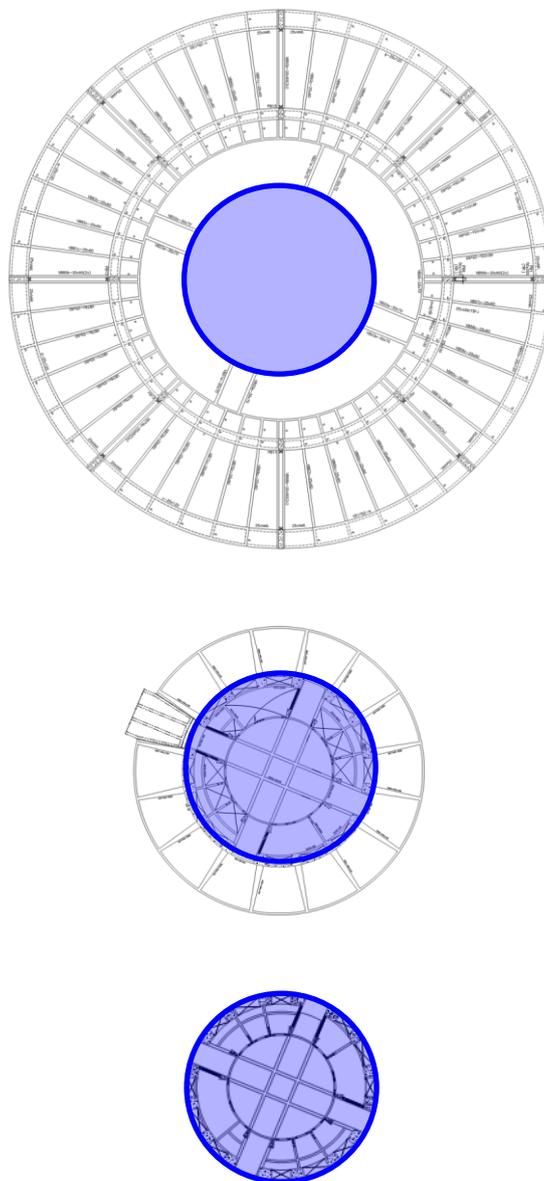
Planta estrutural do Pavimento tipo, Mezanino e núcleo rígido, bloco B.
